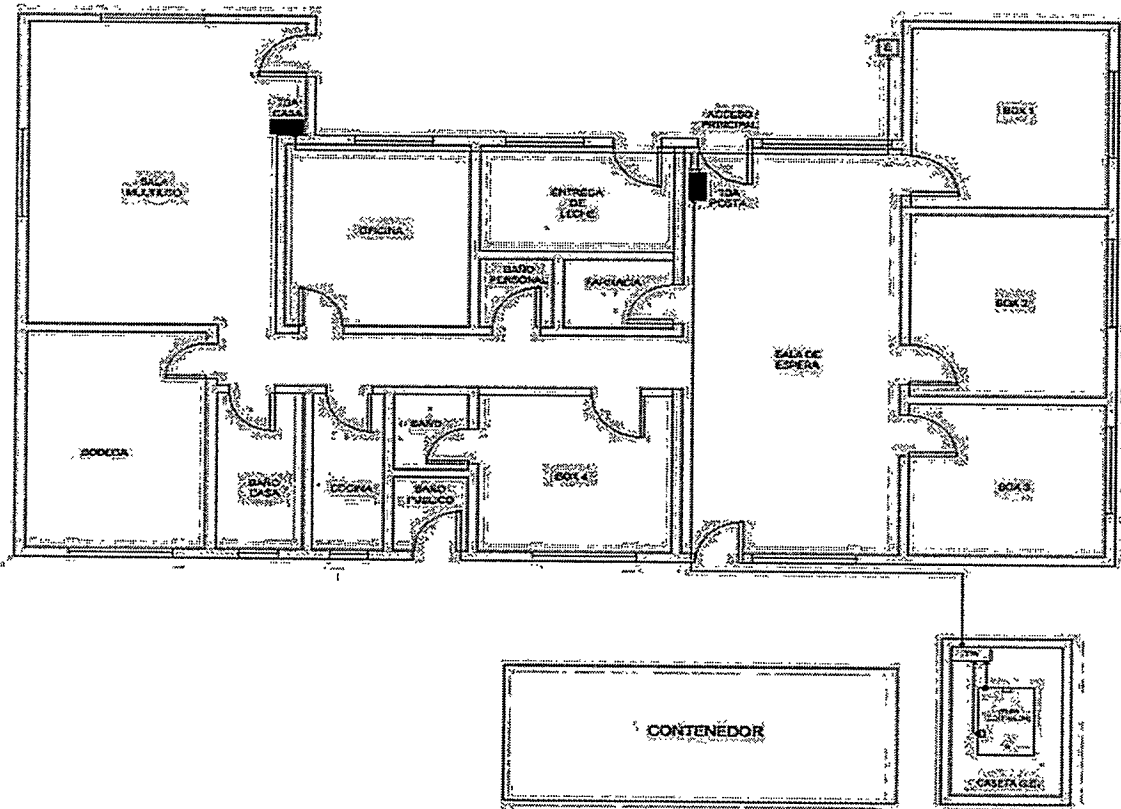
Plano montaje, canalización y conexión de G.E. Posta Lagunillas
